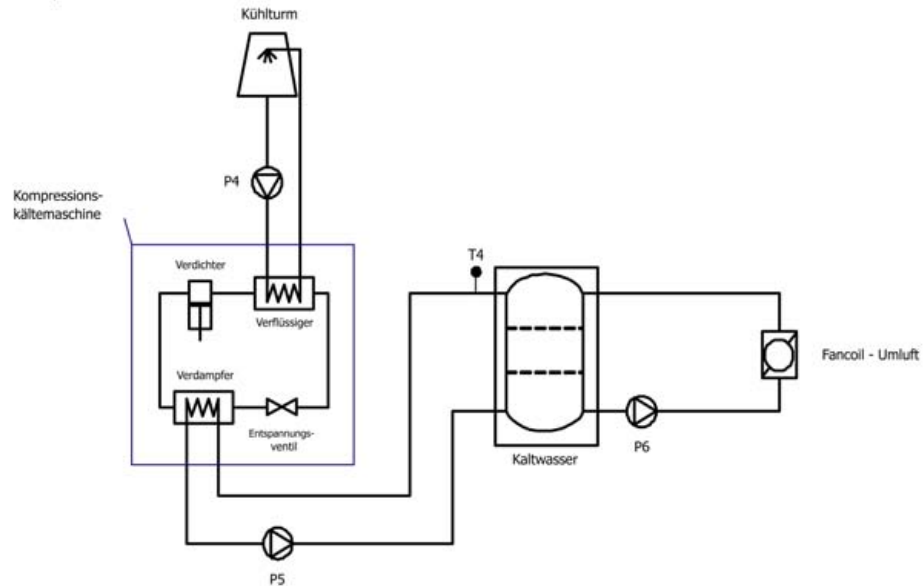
Kühlsystem mit Kompressionskältemaschine.
